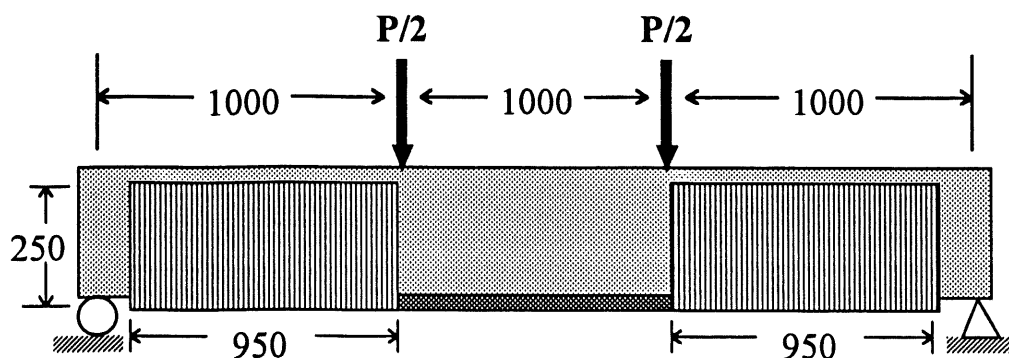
Poutre P1 avec ancrages en U unidirectionnels
